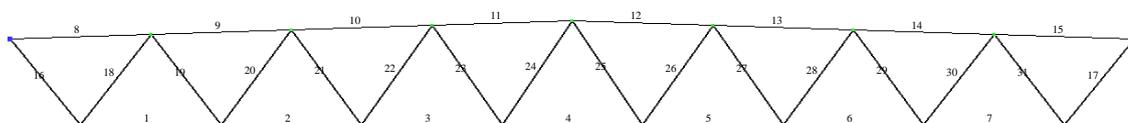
«Конечно-элементная модель стропильной фермы ФС-1» [1]
